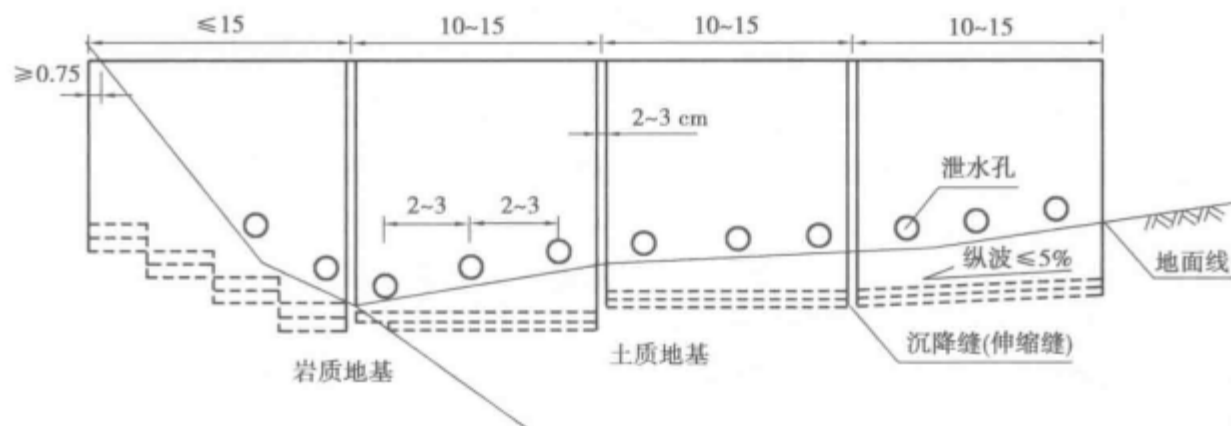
挡土墙纵向布置图(尺寸单位:m)
